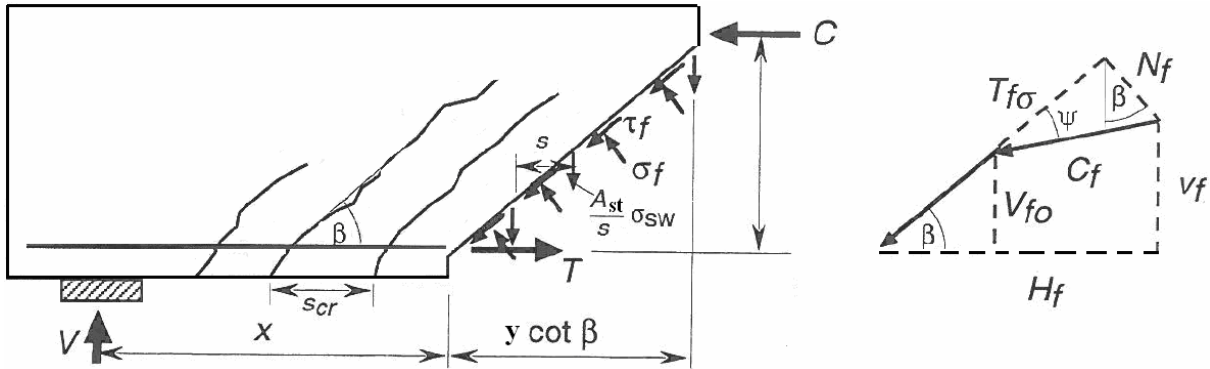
Représentation des efforts agissants au niveau des fissures inclinées [poutre armée transversalement] (Reineck, 1991b)
